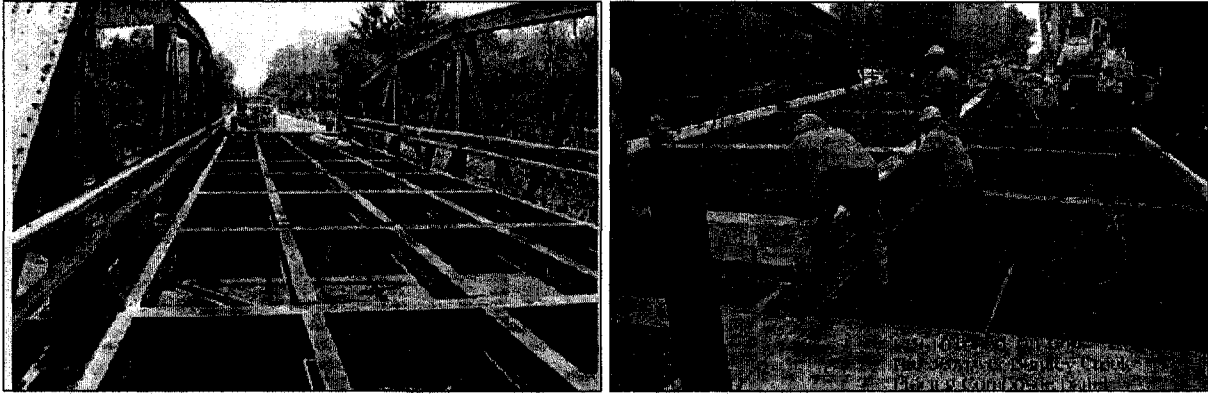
Pont *Bentley Creek* : structure en acier dépouillée et installation des dalles en PRF. (Source : ALAMPALLI et coll., 2001)
